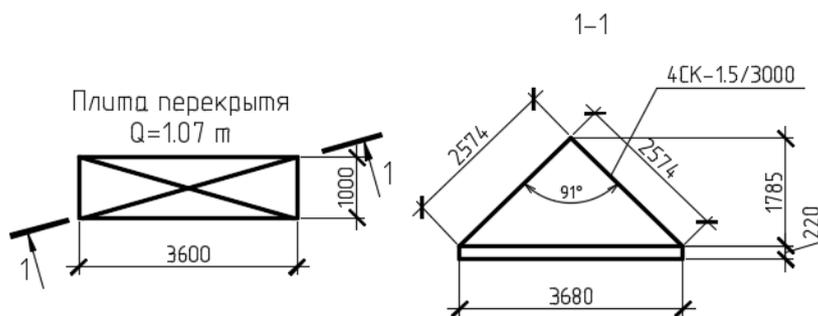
Определение длины стропы для монтажа наиболее удаленной по высоте плиты покрытия
